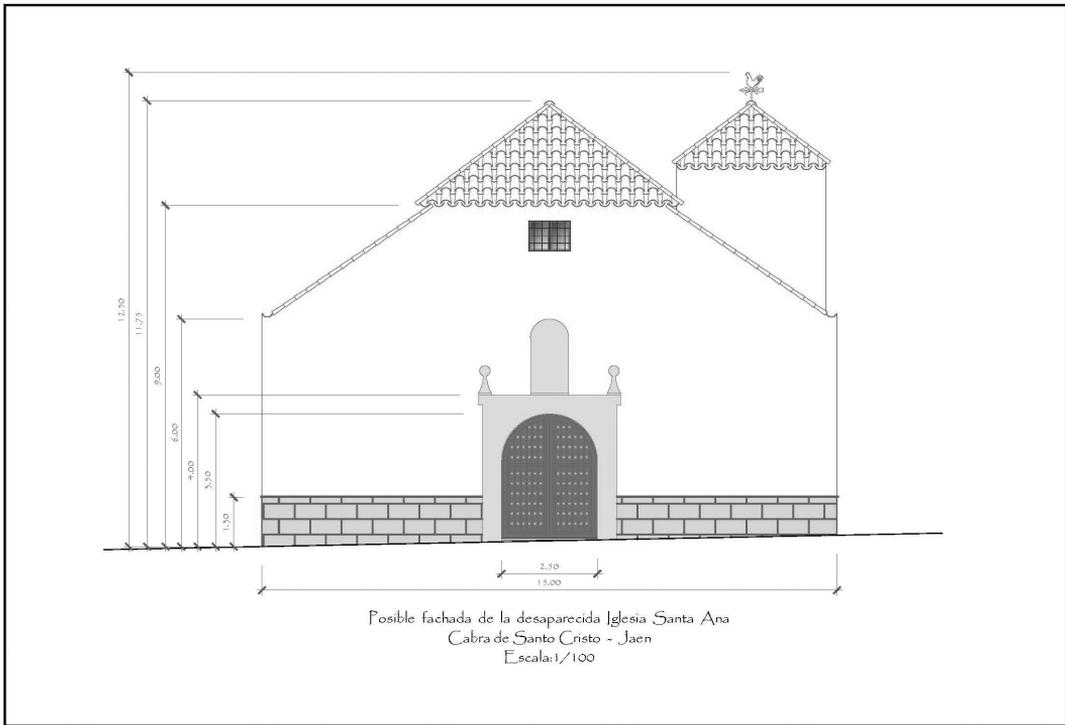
Propuesta de alzado Norte de la desaparecida ermita de Santa Ana.
